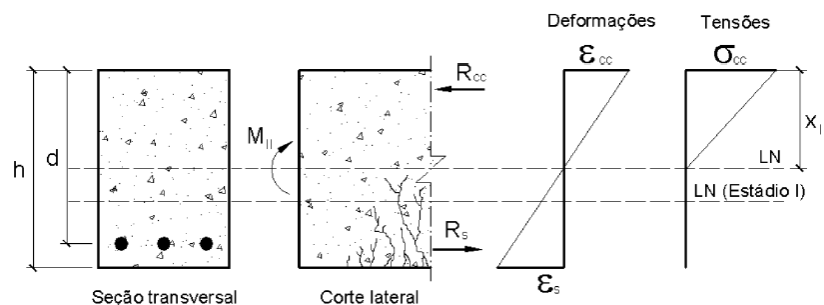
Comportamento de seção transversal de viga de concreto armado no estágio I.
